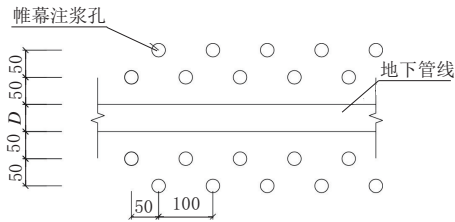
帷幕注浆平面布置示意图(地下管线保护)(单位:cm)
